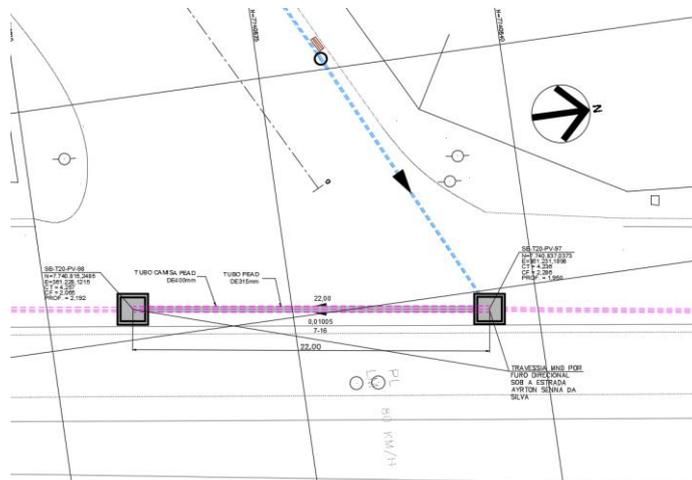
Planta de localização da travessia SB-T20 - PV-97 AO PV-98
